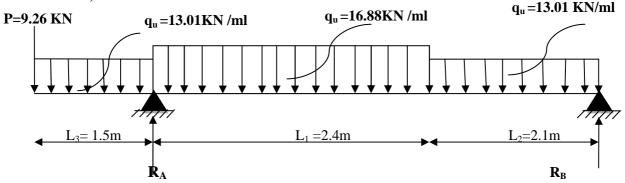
Schéma statique d'escalier à l'ELU.
